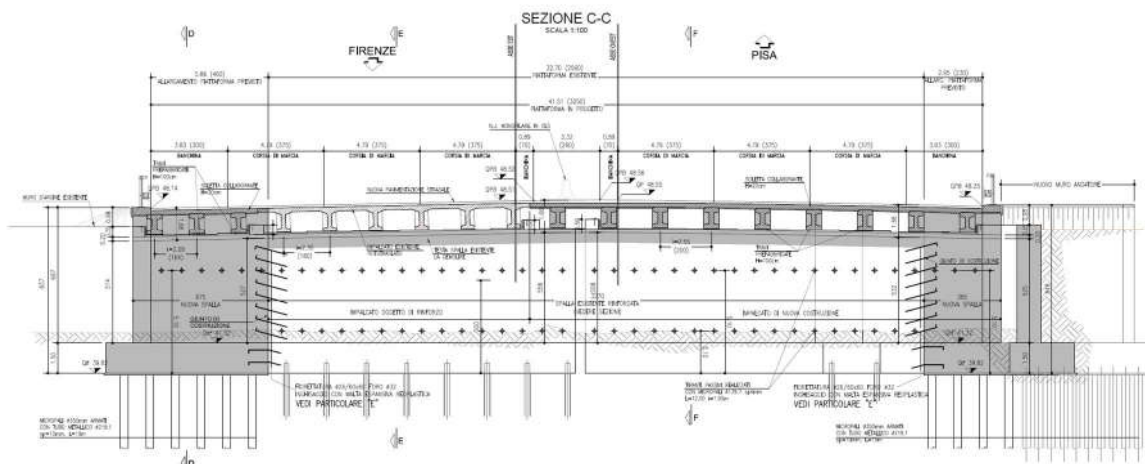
Ponte sul T. Marina. Sezione trasversale.
